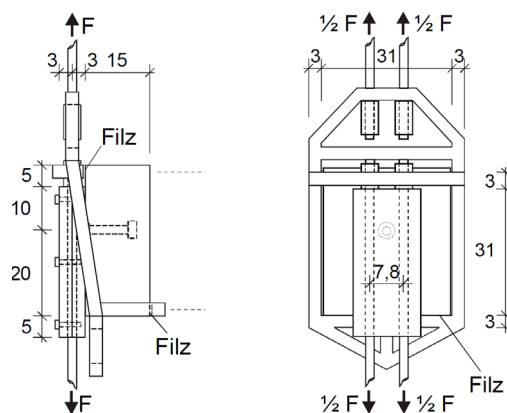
Single-Push-Out-Versuchsaufbau für Kopfbolzendübel nach [Döinghaus 2001] in Seitenansicht (links) und Frontalansicht (rechts)
